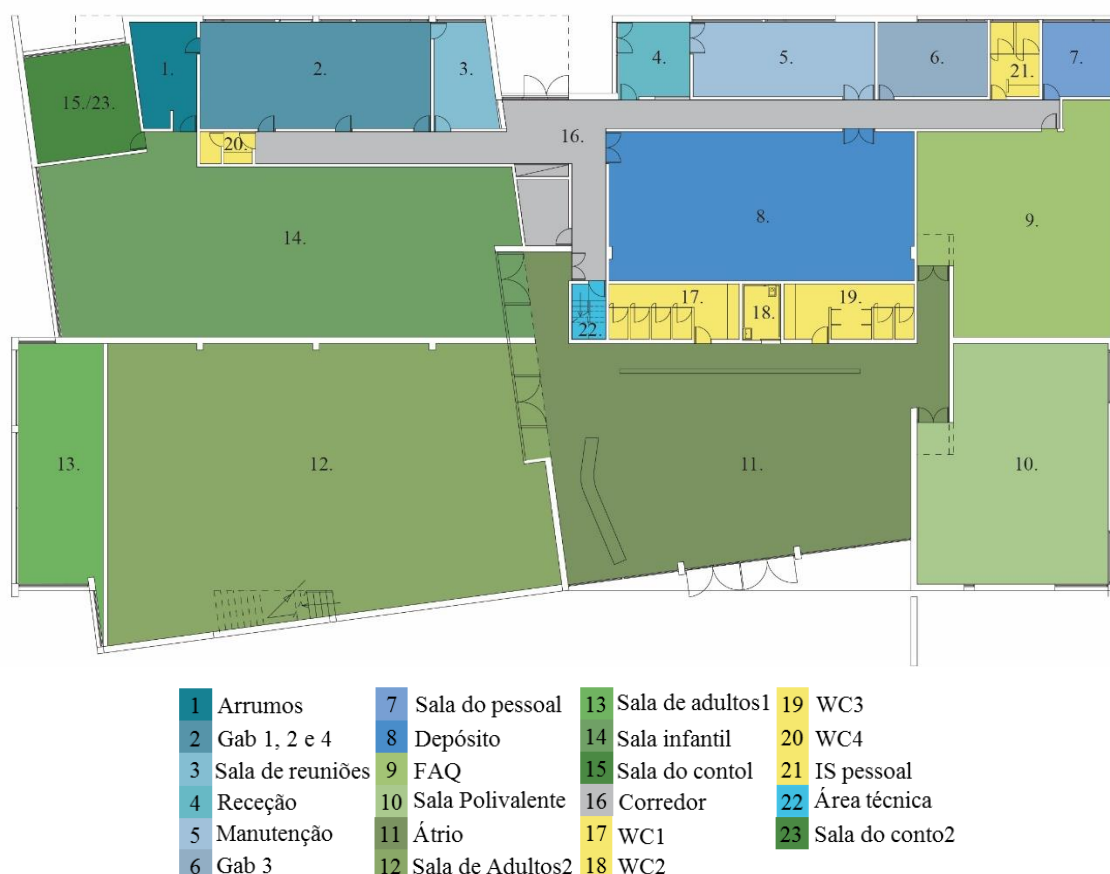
Planta da BMLS e respectiva divisão em zonas térmicas
